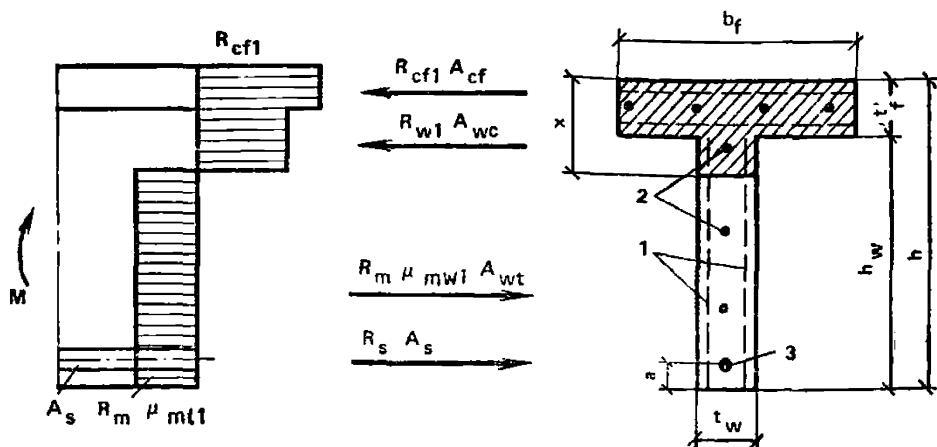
Схема усилий и эпюра напряжений в изгибаемых элементах таврового сечения с полкой в сжатой зоне при $x \leq l'$,
